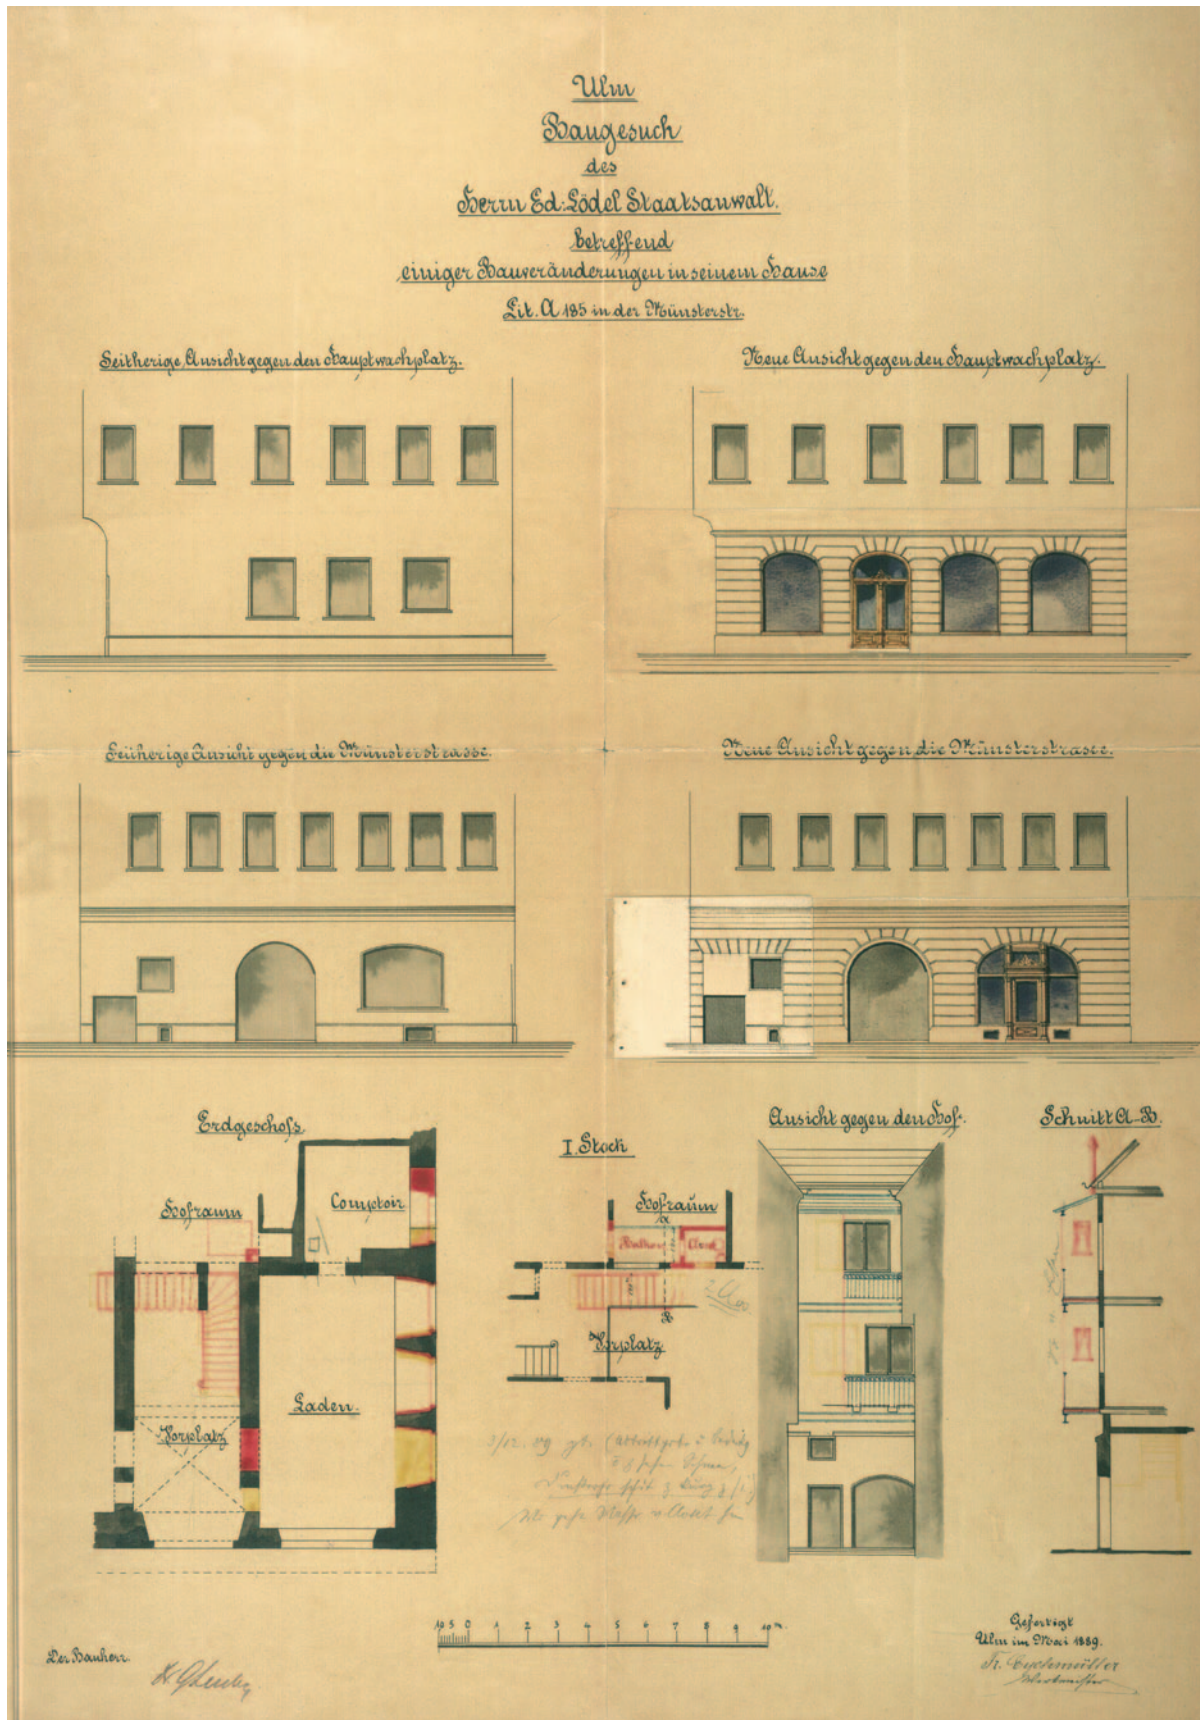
Gebäude Lange Straße 8 (A 185), Teilansichten nach dem Umbau im Jahre 1889.
